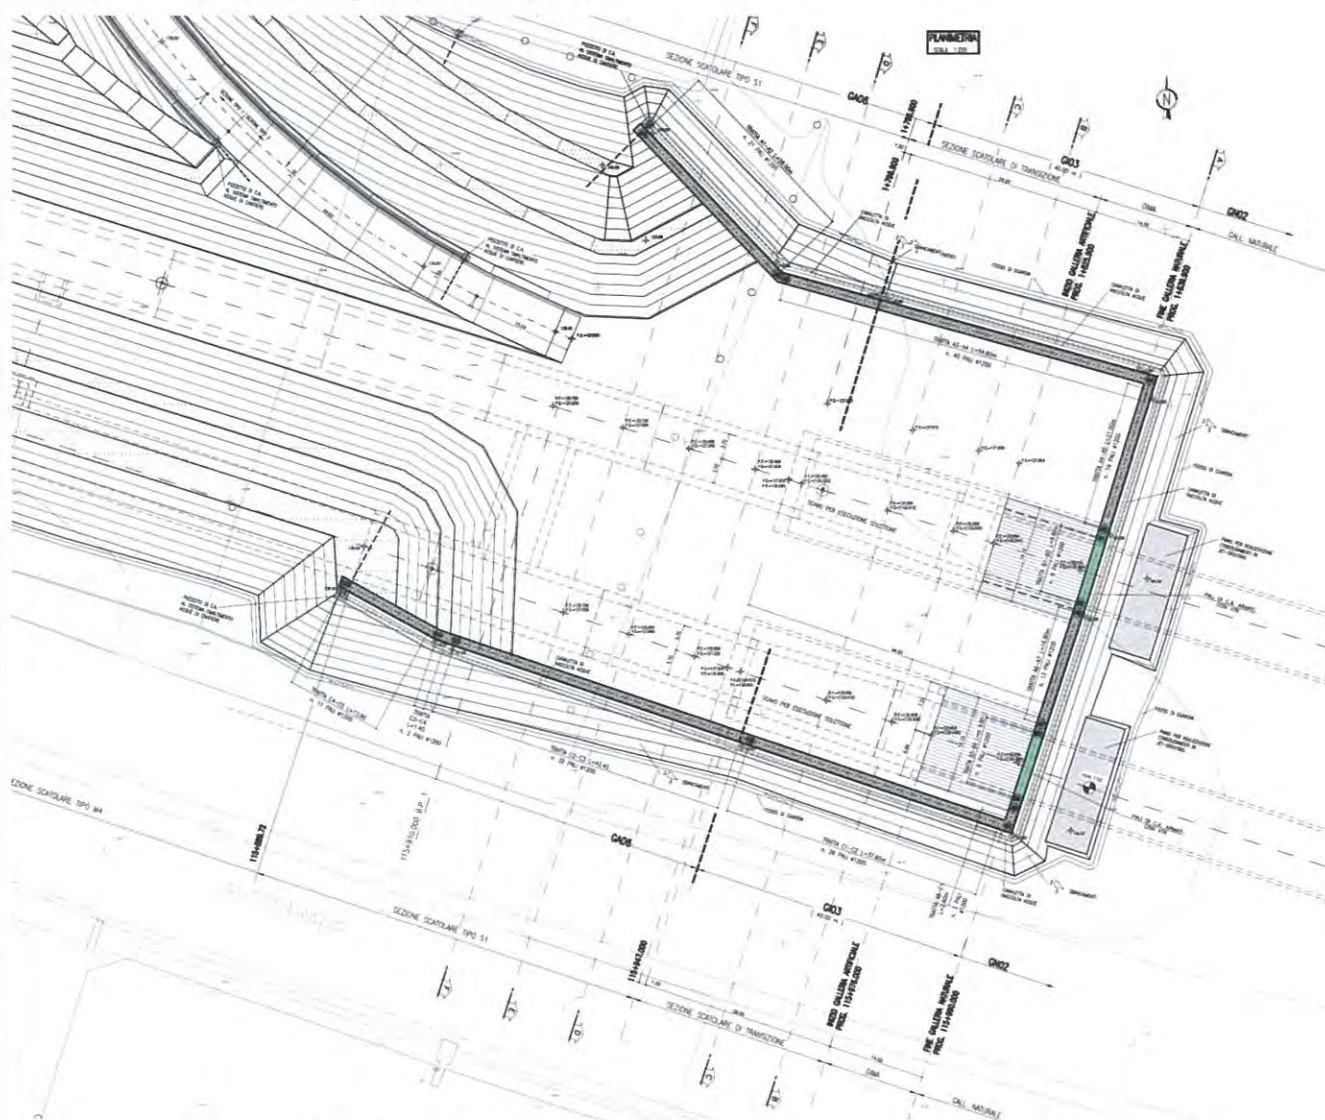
Planimetria nella zona di imbocco della galleria naturale lato Milano (GI03)
